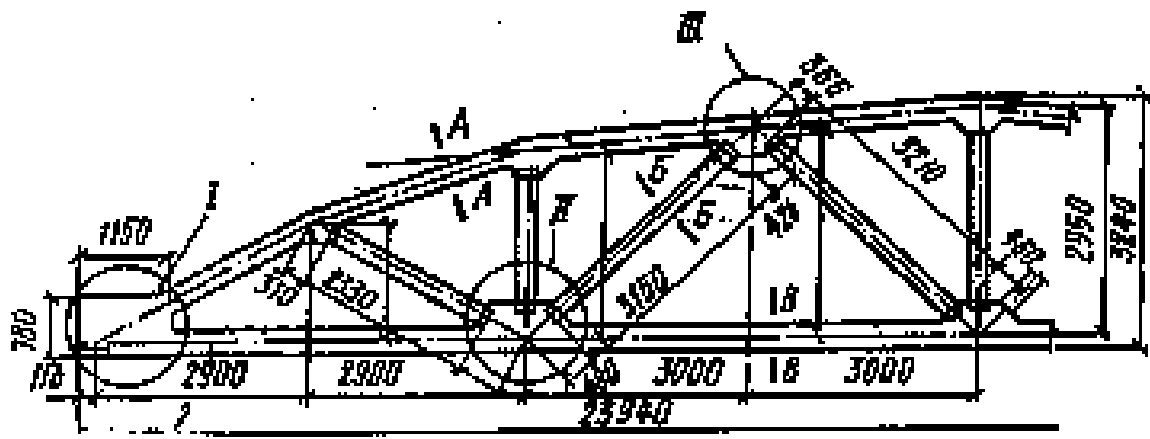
Железобетонная сегментная ферма пролетом 24м:
